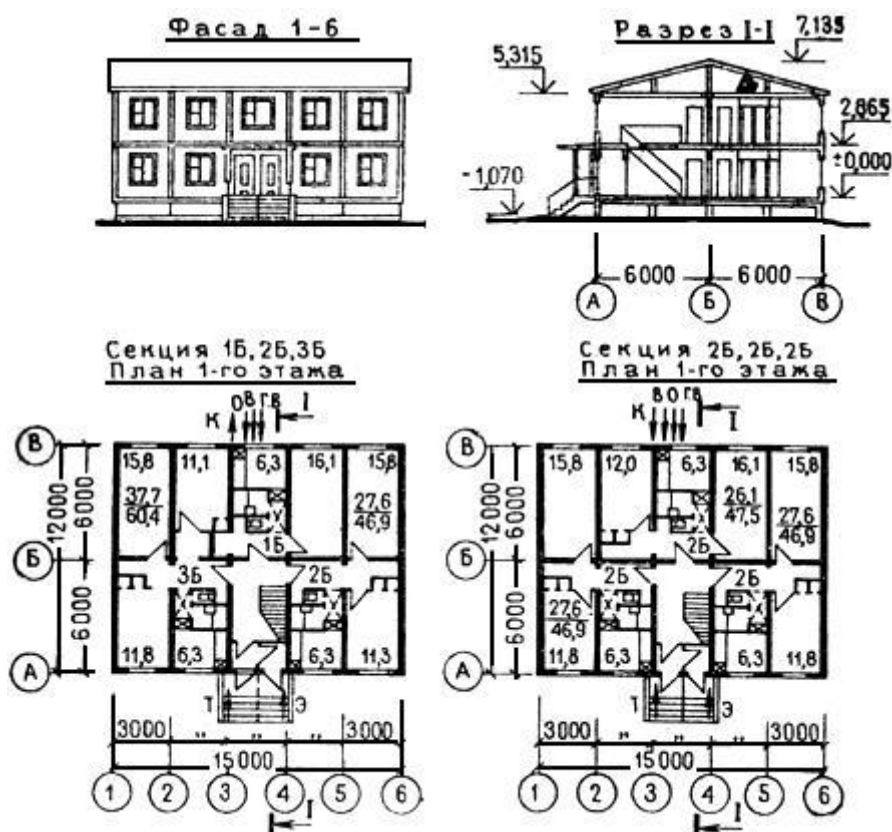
Жилой дом с двумя однокомнатными квартирами и двумя двухкомнатными квартирами, двумя трехкомнатными квартирами жилой площадью 164 м² и общей площадью 283,6 м² или шестью двухкомнатными квартирами жилой площадью 166 м² и общей площадью 283,6 м².
